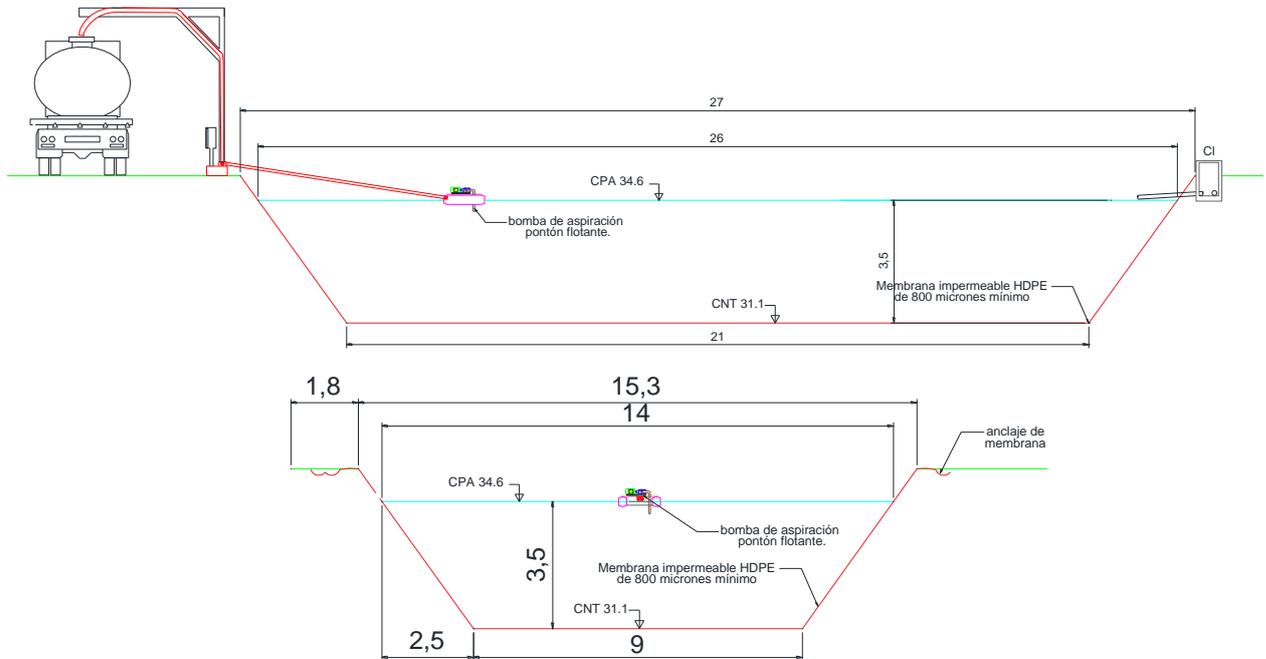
Detalle Laguna de Sedimentación - Vista de perfil longitudinal y transversal.
